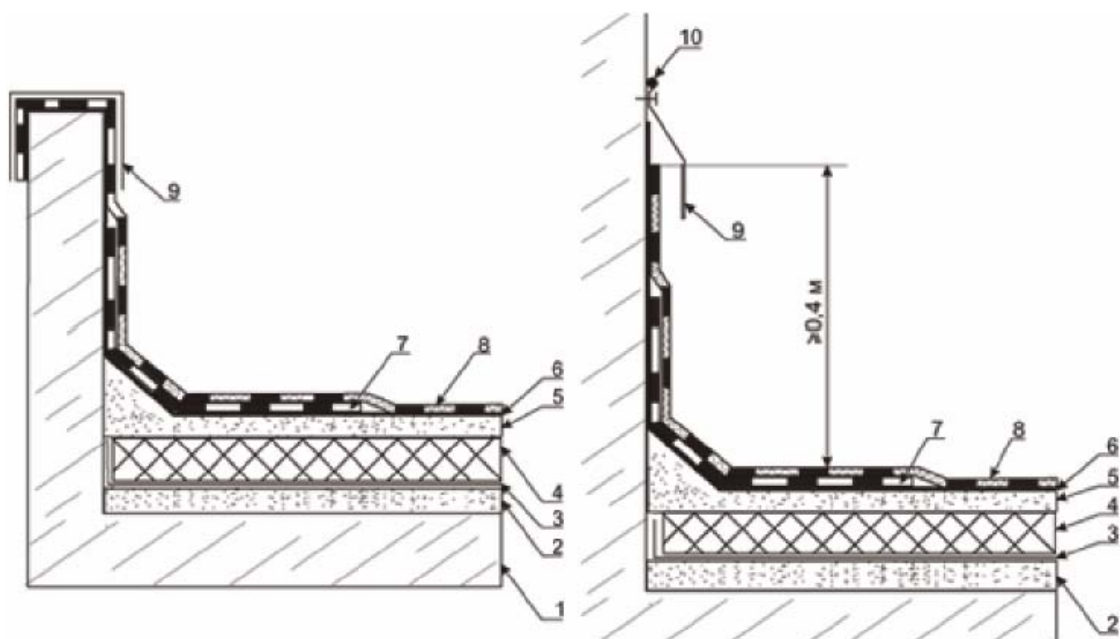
Примыкание кровли к парапету или к стене для традиционной кровельной системы. (Неэксплуатируемое покрытие).
